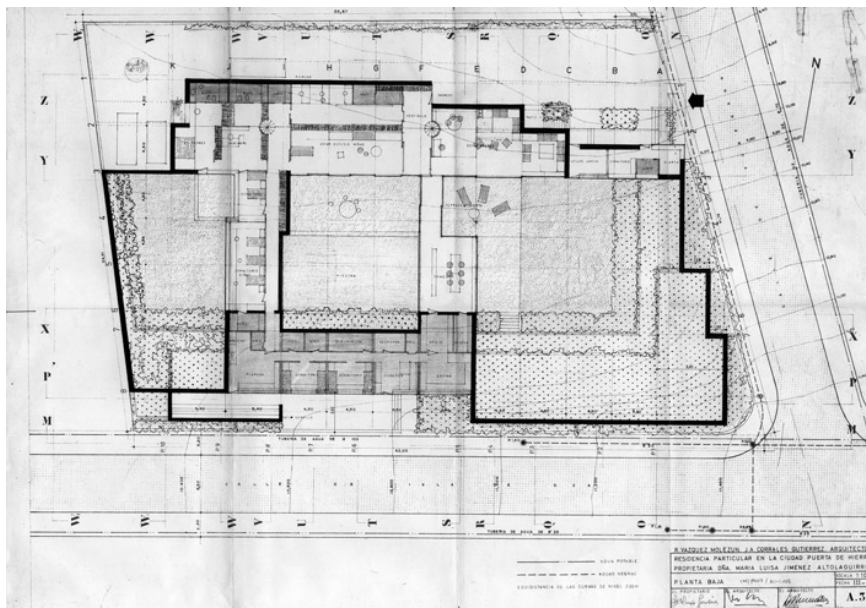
Casa Huarte. Plano A-3 de Planta Baja. Proyecto de Ejecución. Marzo 1965.
